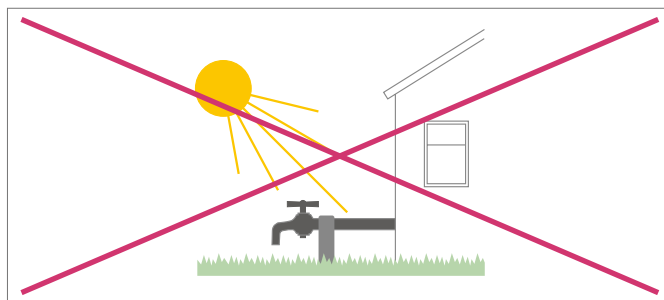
Укладка вне зданий труб для водопроводов возможна только с принятием соответствующих защитных мер
